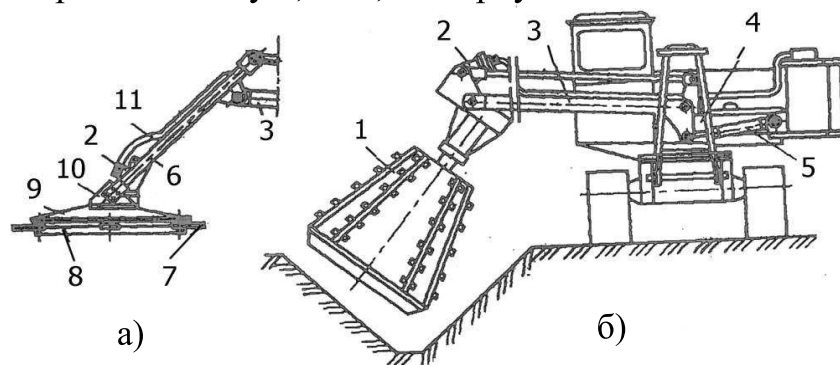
Каналоочиститель лесной навесной КЛН-1,2: а – сменный рабочий орган; б – с фрезой: 1 – фреза; 2 – гидромотор; 3 – стрела; 4 – колонка; 5 – гидроцилиндр подъема стрелы; 6 – удлинитель; 7 – нож; 8 – ротор; 9 – кожух; 10 – редуктор; 11 – трубопровод
